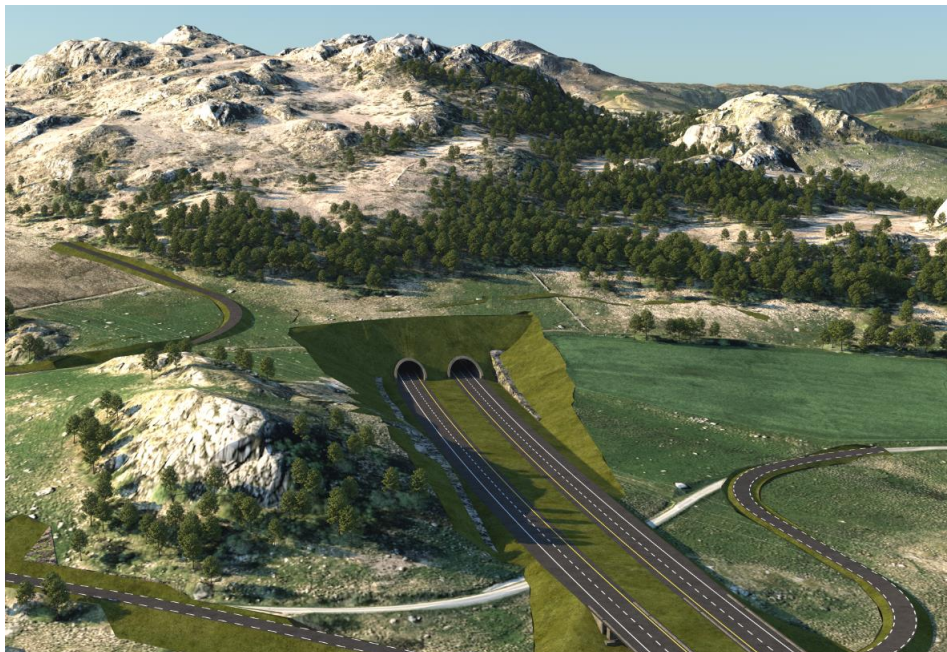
Strekning C. Kryssing kulvert omlagt kjørevei Solheim.
